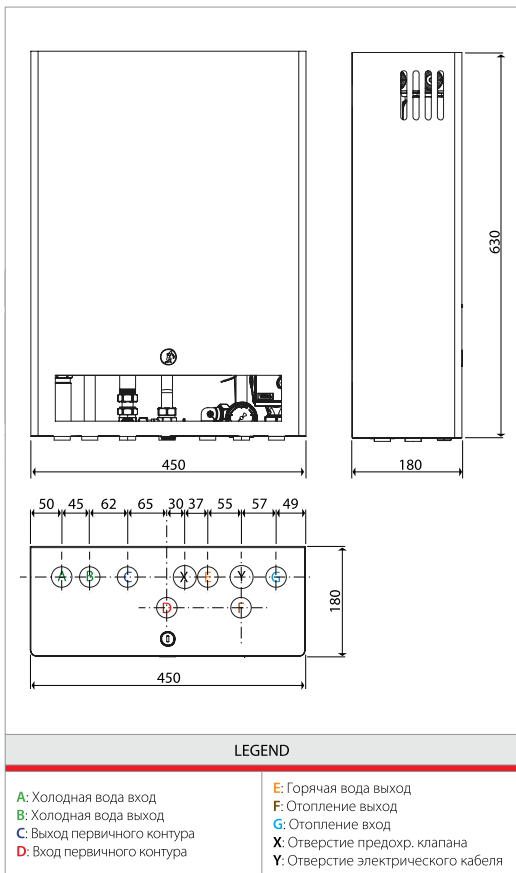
Общий вид и габаритные размеры (GE556Y175)
